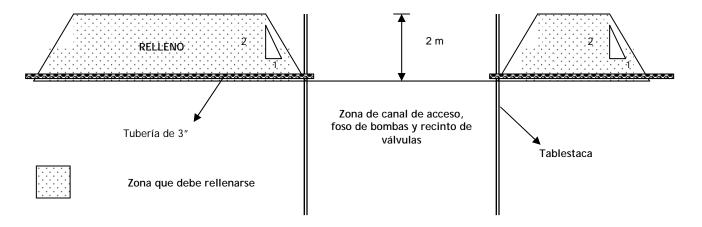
Detalle de las Zonas que deben Rellenarse - Corte 1-1-Perfil
